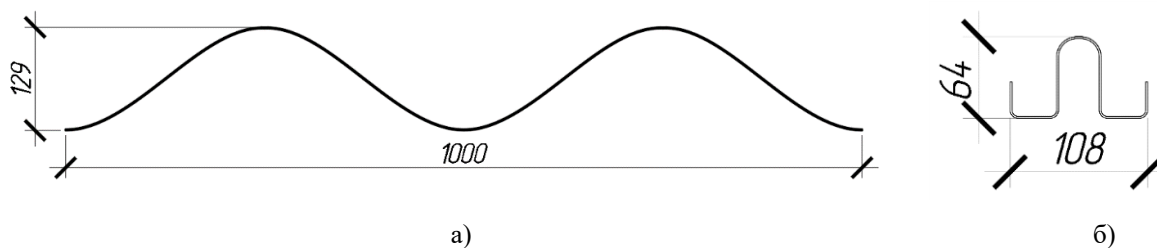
Сечения металлоконструкций: а) волнистого металлического листа стены; б) раскосов конструкции кровли
